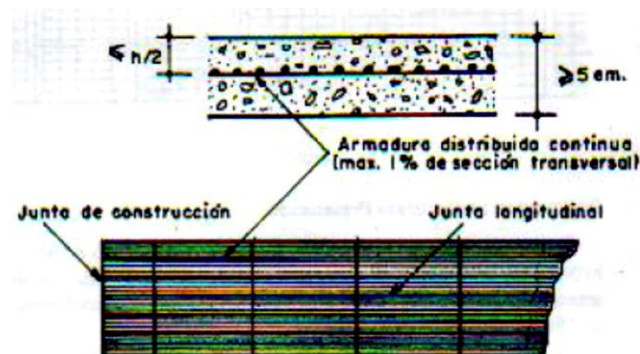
Gráfica de Pavimento Rígido con Refuerzo Continuo
